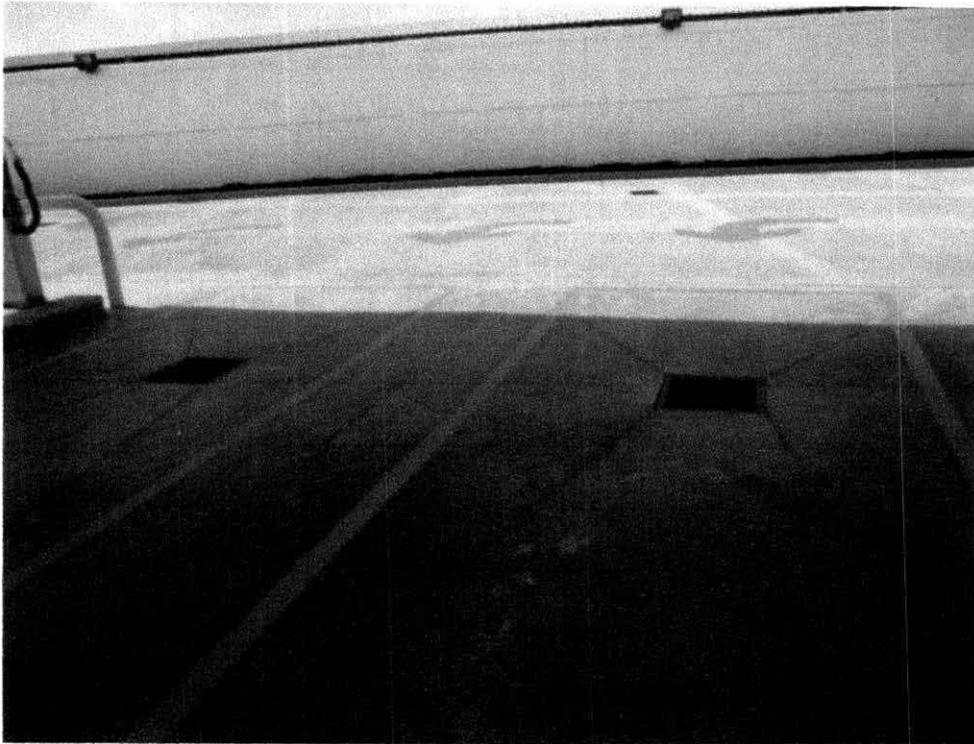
Vista de las trampas de grasas y combustibles en la zona de despacho.
